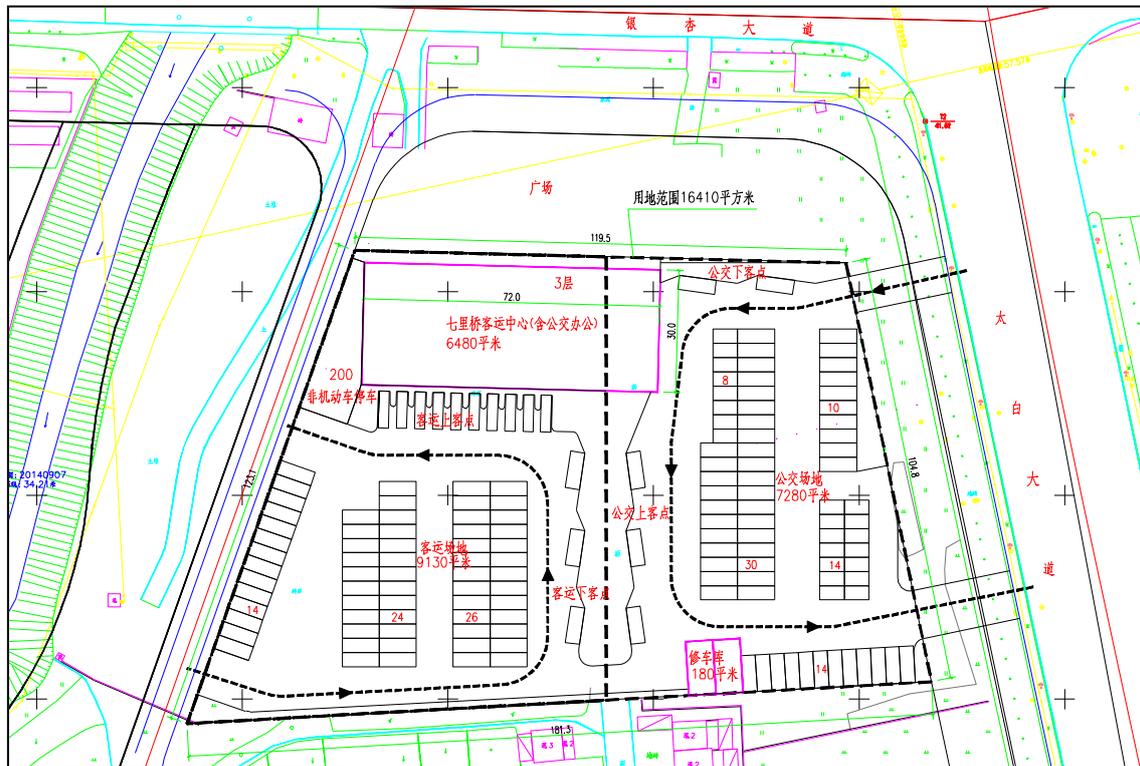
七里桥枢纽平面布局示意图
